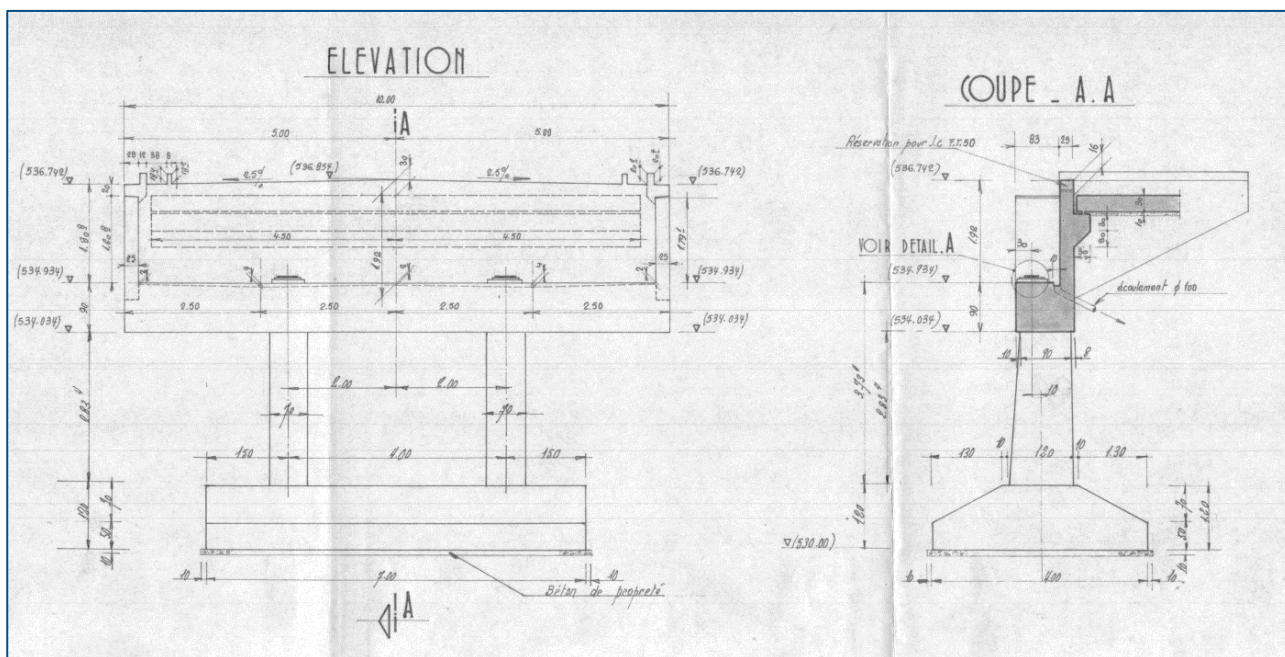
Plan de coffrage culée n°4 – EXE - Archives
